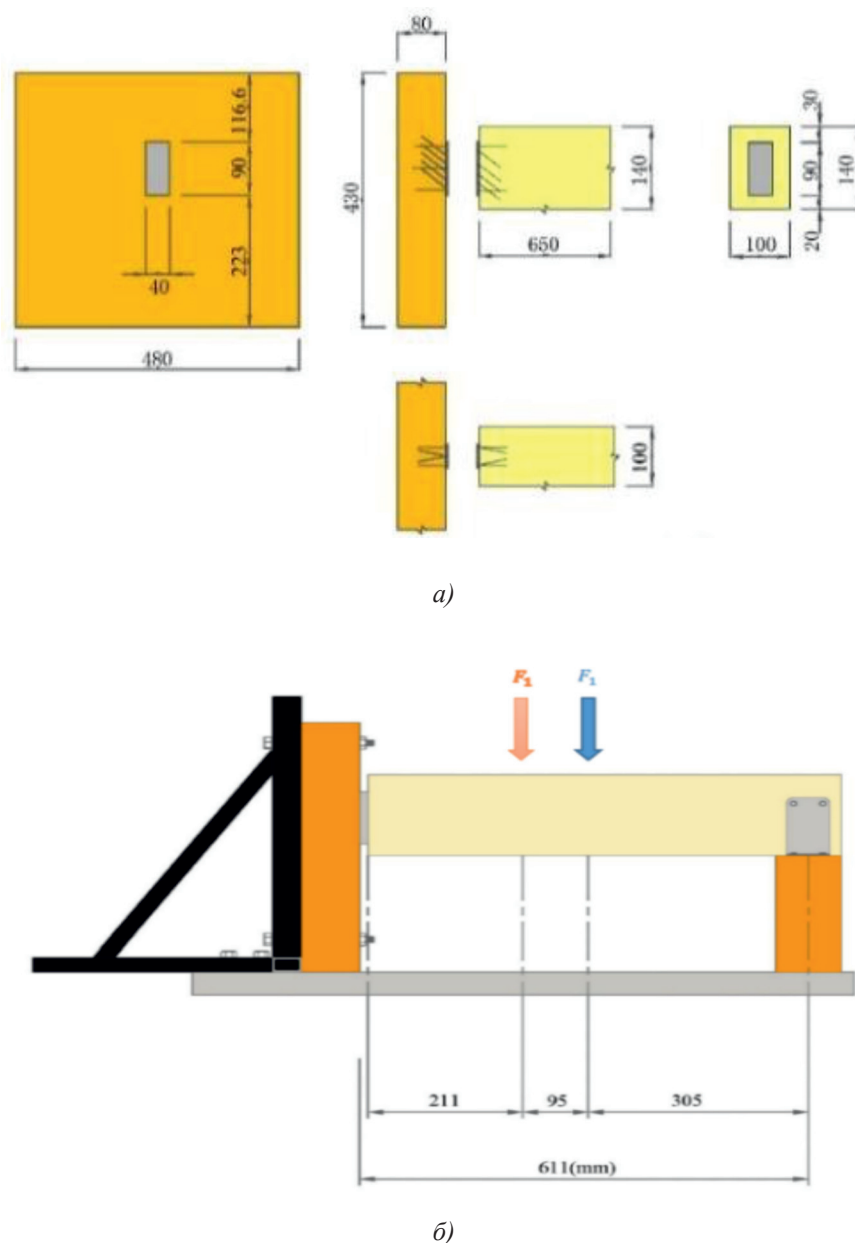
Испытание соединения SHERPA на изгиб: а – расположение соединения SHERPA; б – установка деревянных опытных образцов на экспериментальном стенде
